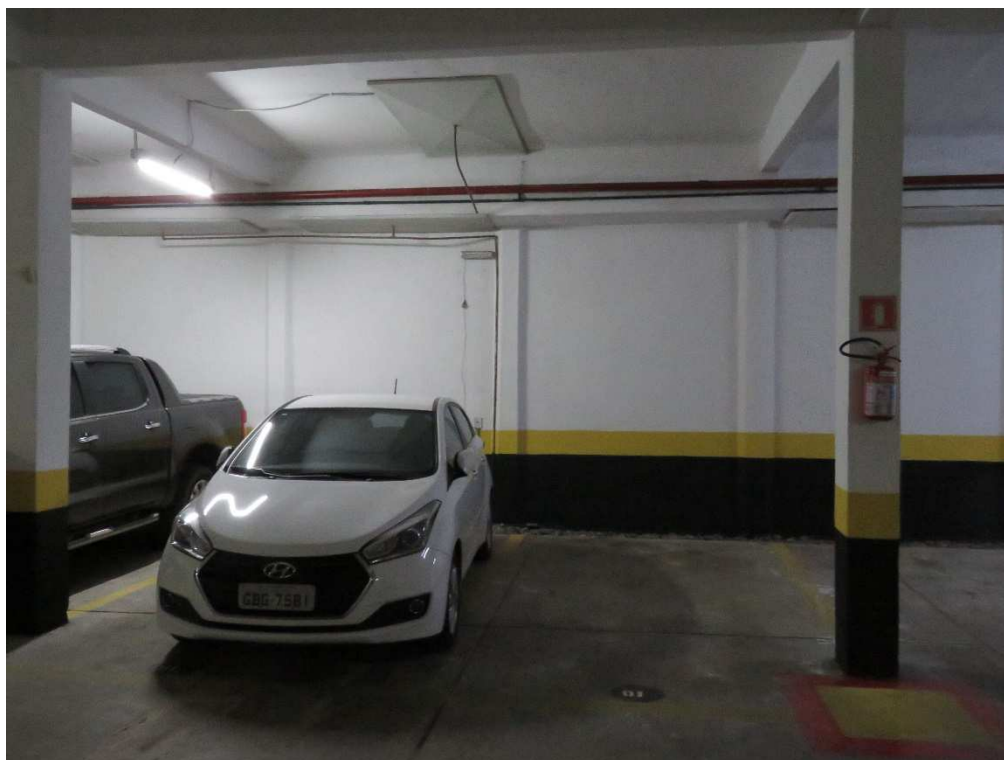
Vagas do apartamento 91; notam-se bandejas e tubulações para conter infiltrações na laje devido a falhas de impermeabilização da laje
